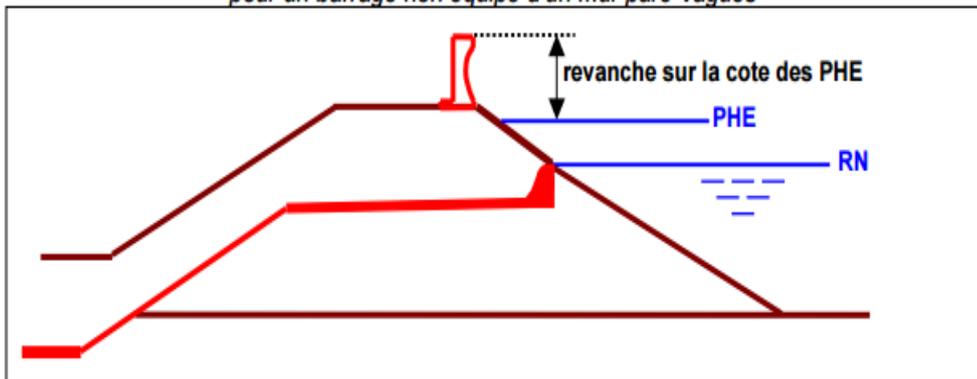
Revanche sur les PHE pour un barrage équipé d'un mur pare-vagues
